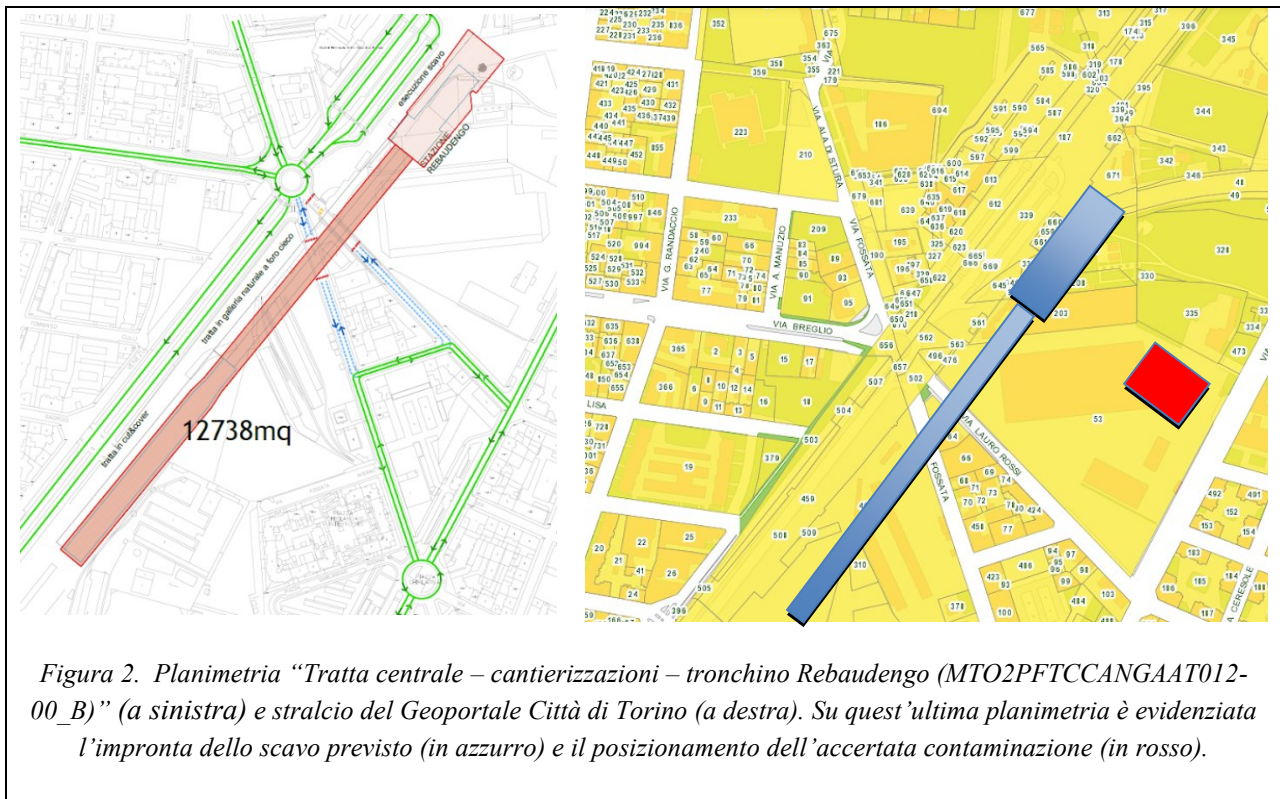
Planimetria “Tratta centrale – cantierizzazioni – tronchino Rebaudengo (MTO2PFTCCANGAAT012-00_B)” (a sinistra) e stralcio del Geoportale Città di Torino (a destra). Su quest’ultima planimetria è evidenziata l’impronta dello scavo previsto (in azzurro) e il posizionamento dell’accertata contaminazione (in rosso).
